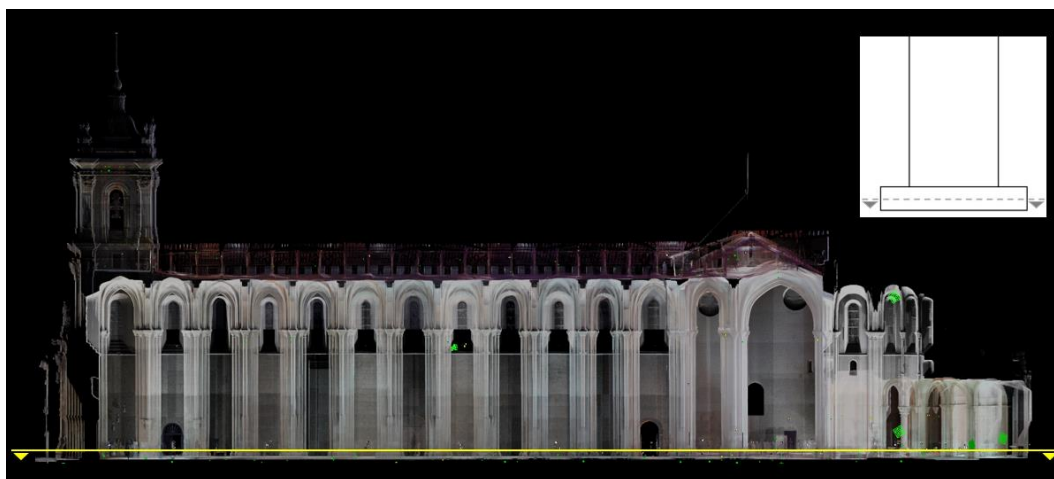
Demonstração do corte em planta pela base dos pilares da cabeceira da Igreja.
